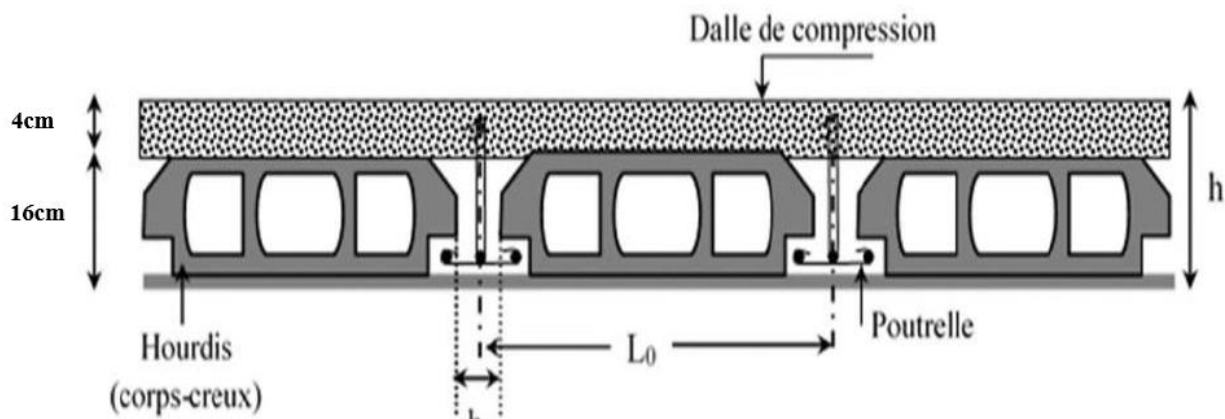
Coupe transversale d'un plancher à corps creux.
